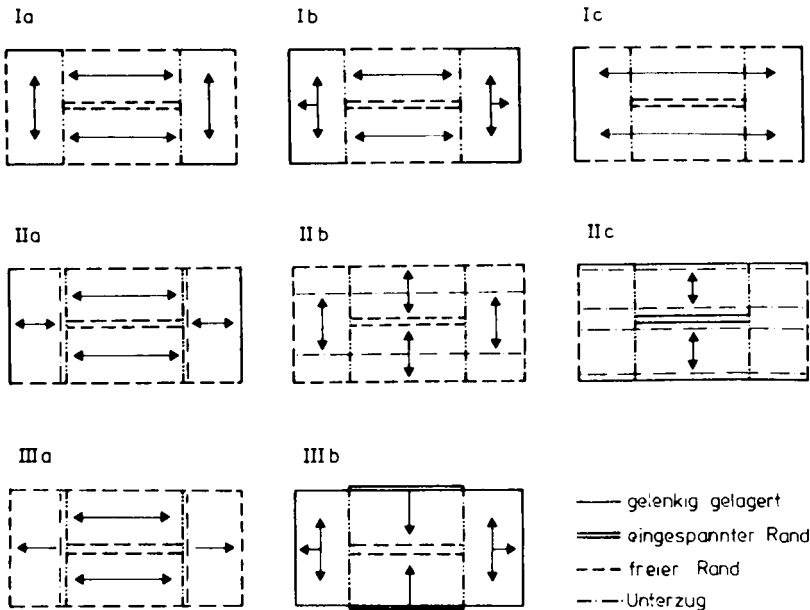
Grundriß gerader, gegenläufiger Plattentreppen mit Podesten, Auflagemöglichkeiten und statische Systeme
